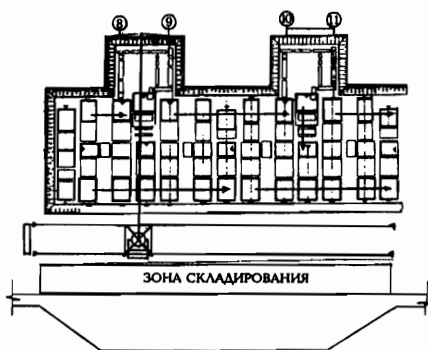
Монтаж фундаментных плит и стеновых блоков подземной части жилого дома; направление монтажа; маячные плиты отмечены маркерами
